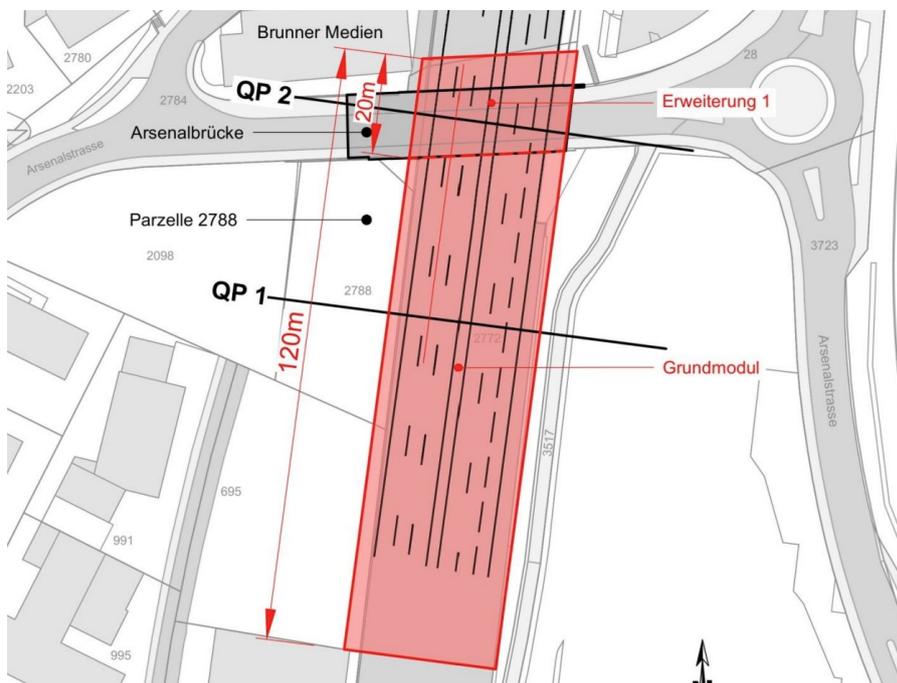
Grundriss Variante 2 gemäss Machbarkeitsstudie Überdeckung Arsenal (Projektpartner)
